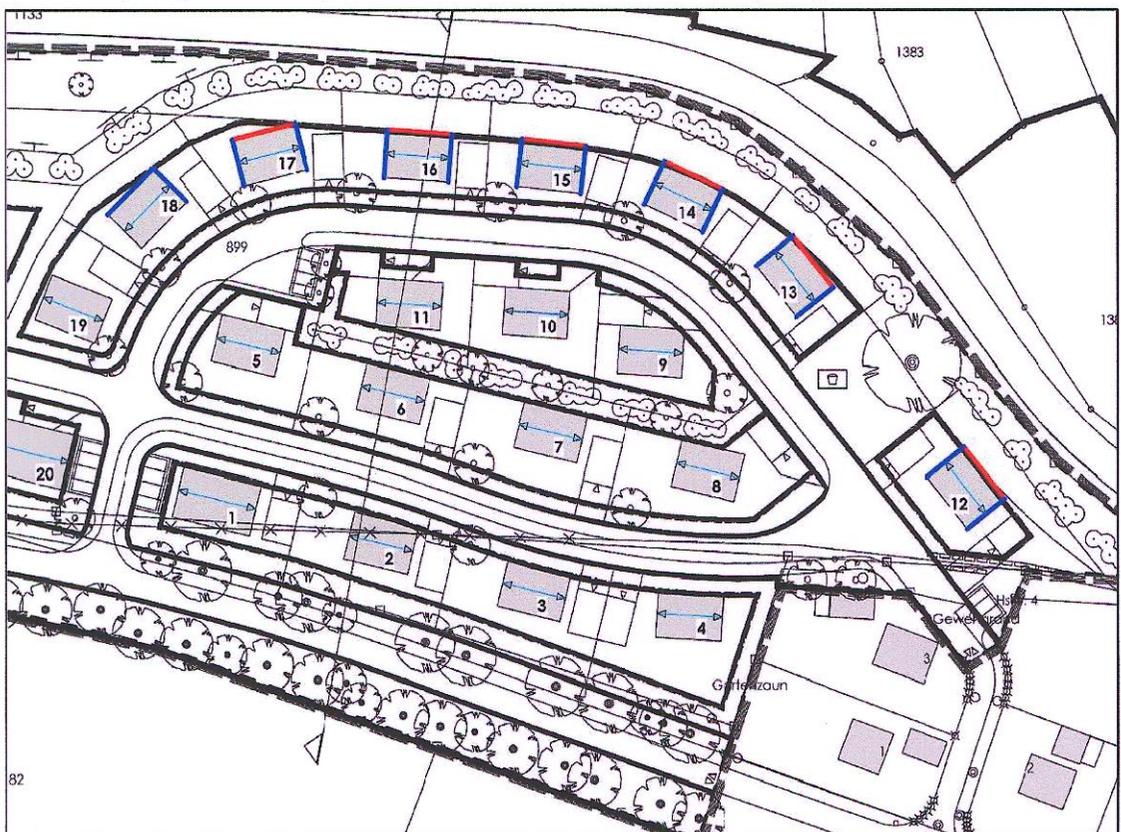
Lageplan mit Kennzeichnung der Fassaden, an denen passiver Schallschutz erforderlich ist (Maßstab 1:1.500).
